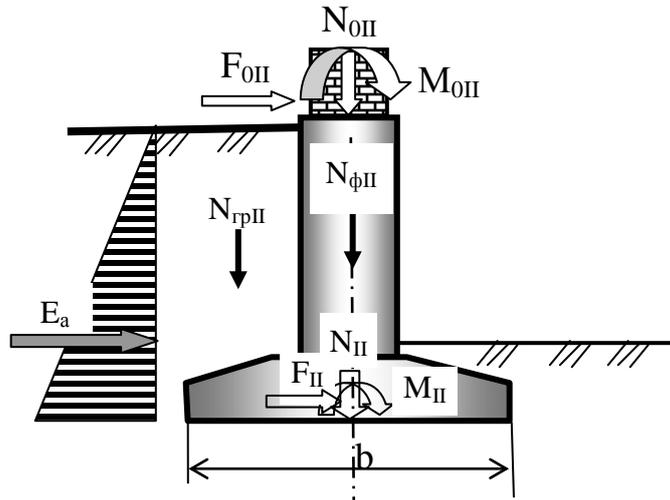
Схема к определению давления по подошве внецентренно-нагруженного фундамента
